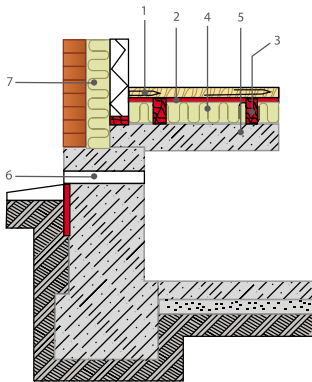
Утепление плитного перекрытия над холодным подвалом с лагами:
